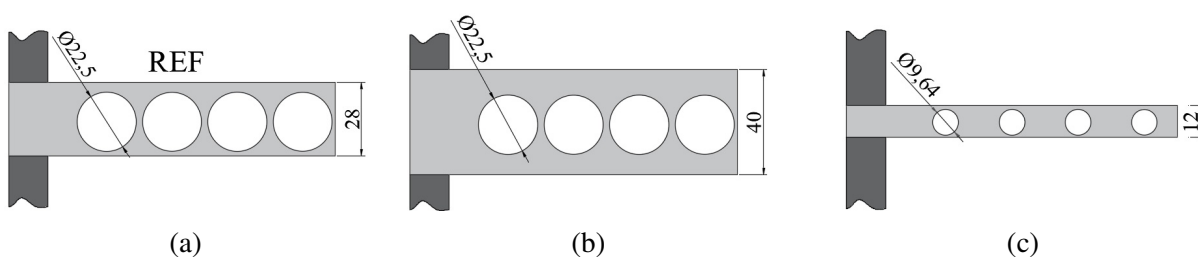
Geometria das lajes com (a) 28, (b) 40 e (c) 12 cm de espessura (cm) (fonte: Autor)
